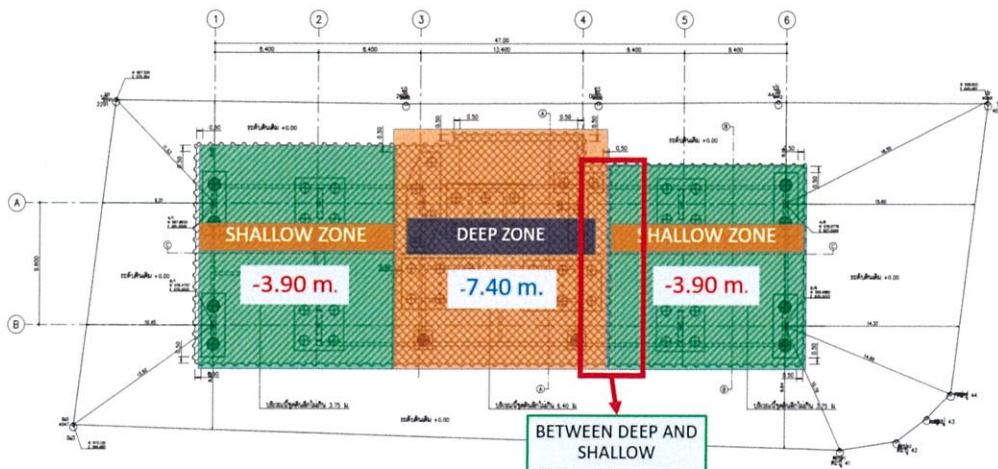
Plan ระดับการขุดดินของ Deep Zone Layer 2
